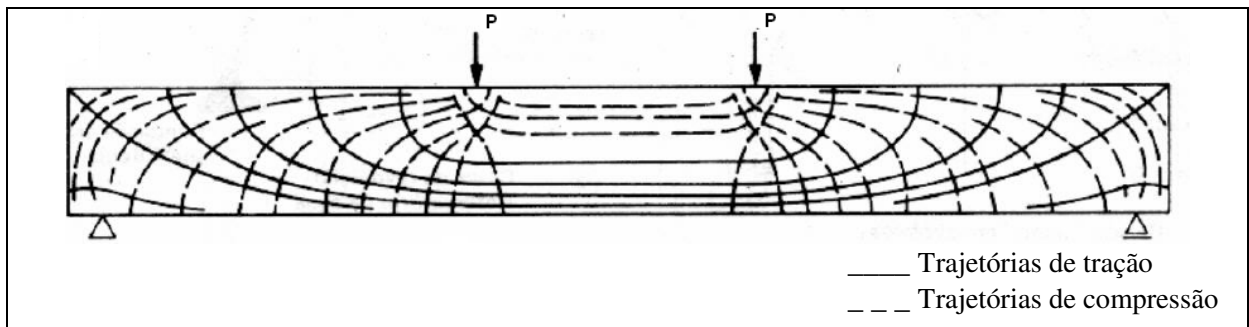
Trajetórias das tensões principais (Viga não fissurada) (SILVA; MELO, 2005).
